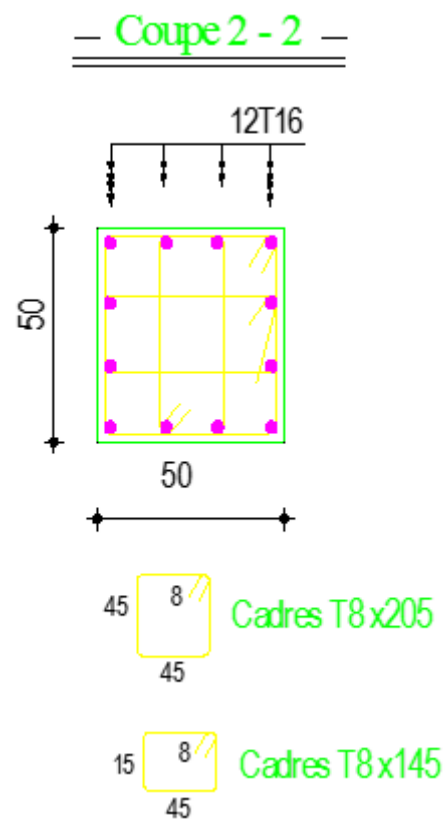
Exemple de ferrailage d'un poteau (50×50)
